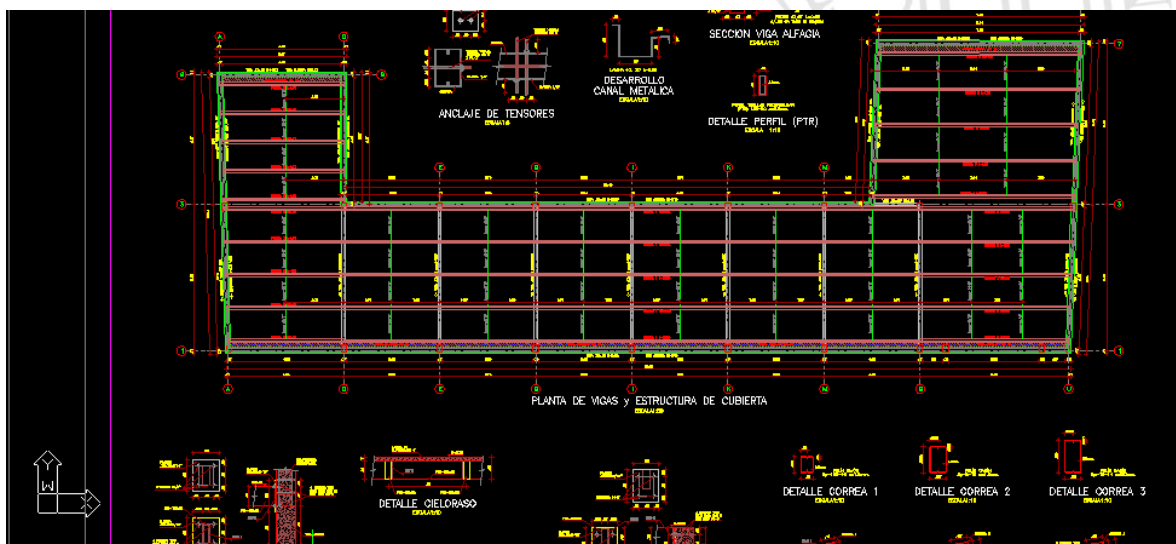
Plano de estructura diseñada en perfilería metálica.
